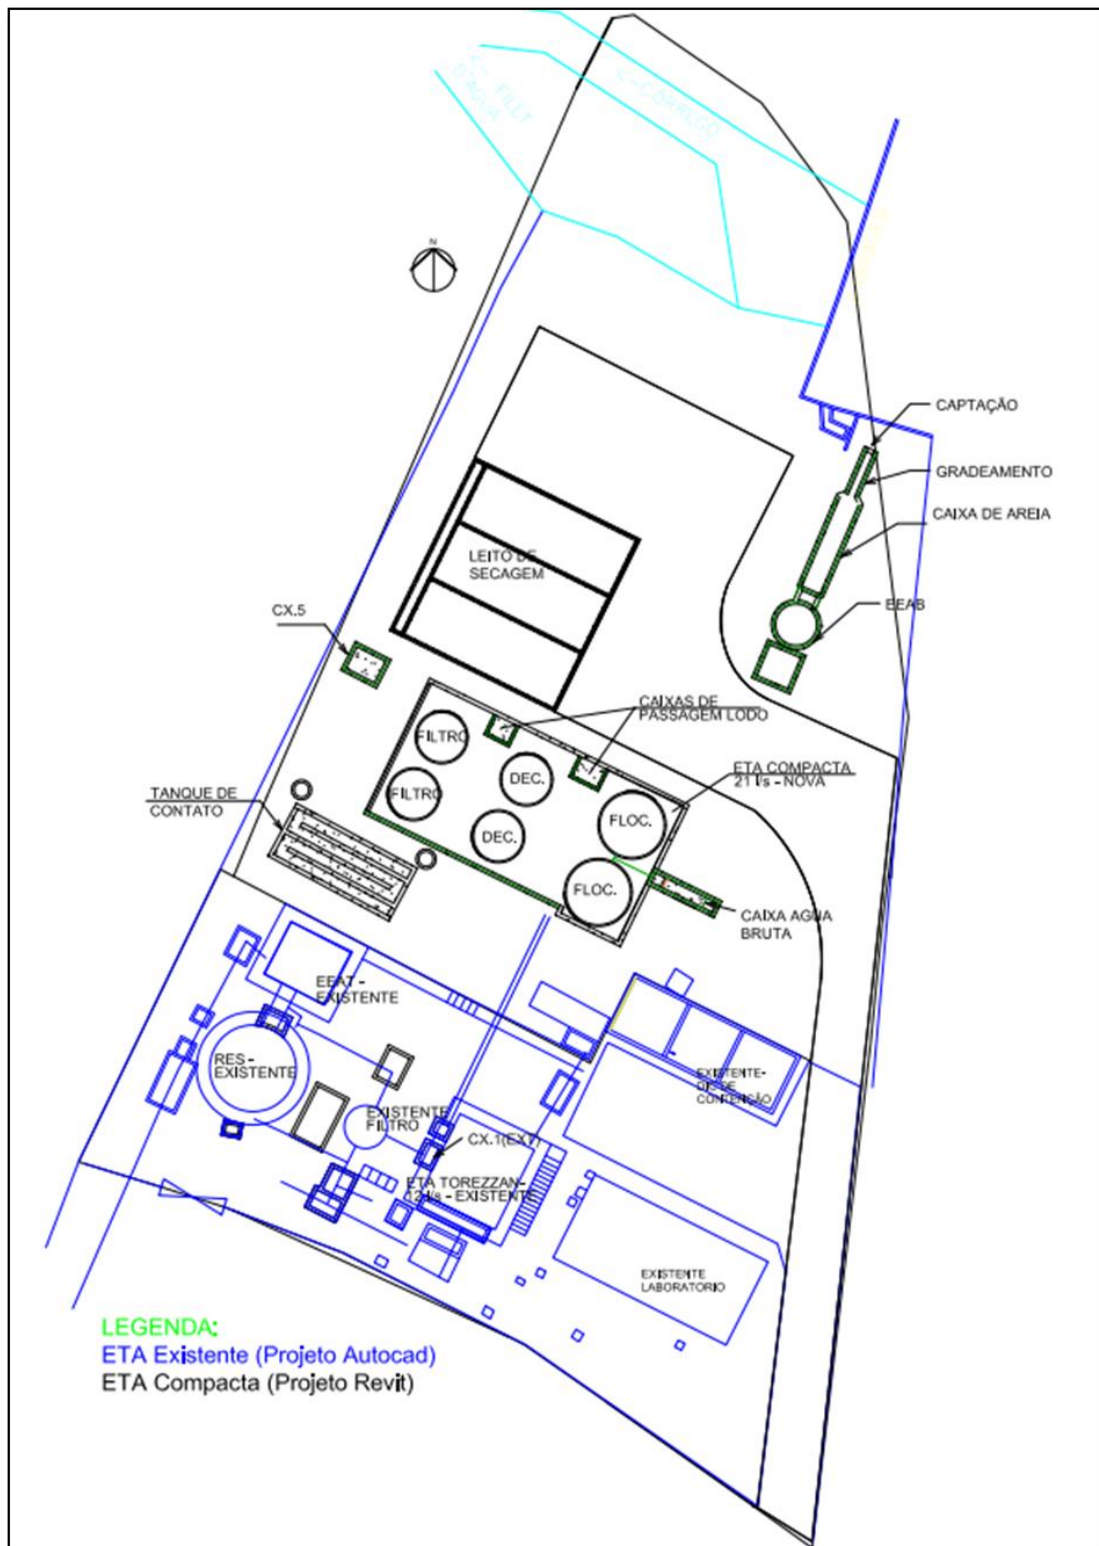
Layout da área nova ETA Compacta e da ETA Torrezan existente.
